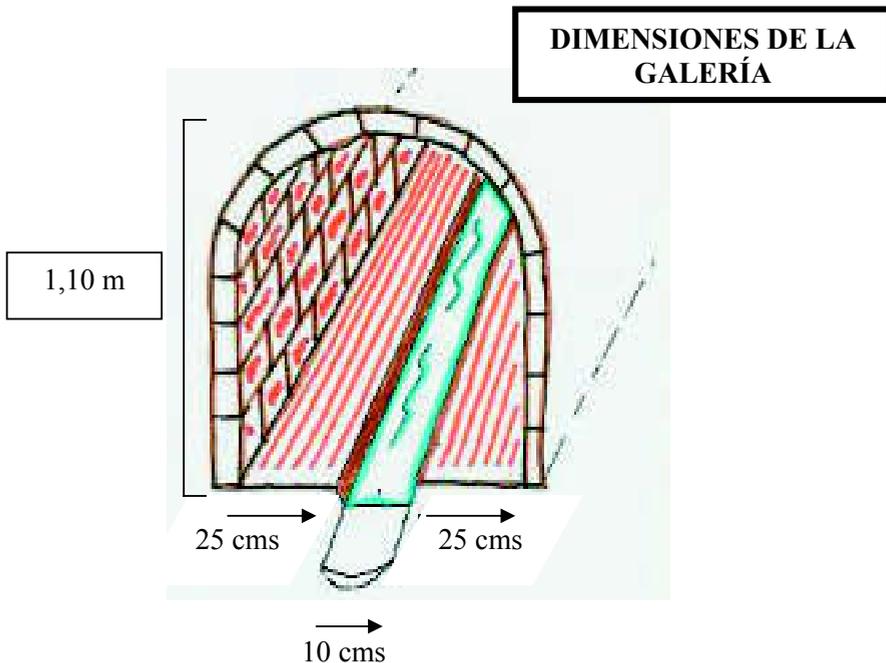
Dimensiones de la galería Las Fontanicas.
